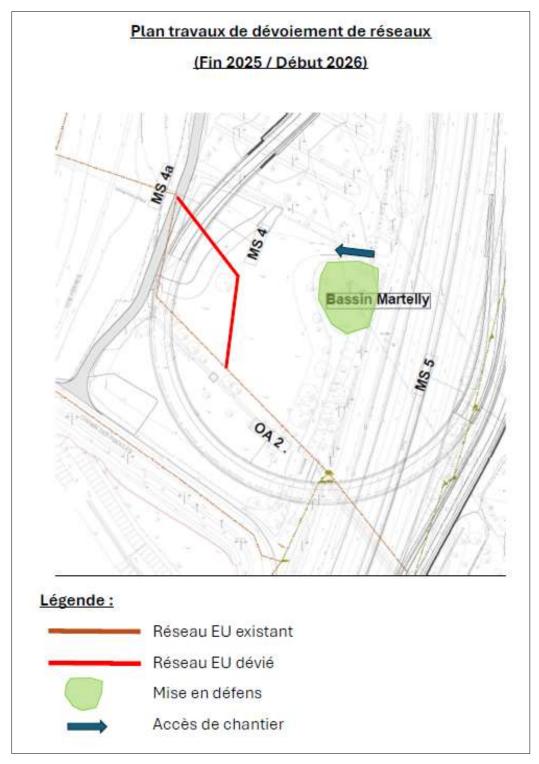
Plan travaux de dévoiement de réseaux au niveau du bassin Martelly (source : ASF)
